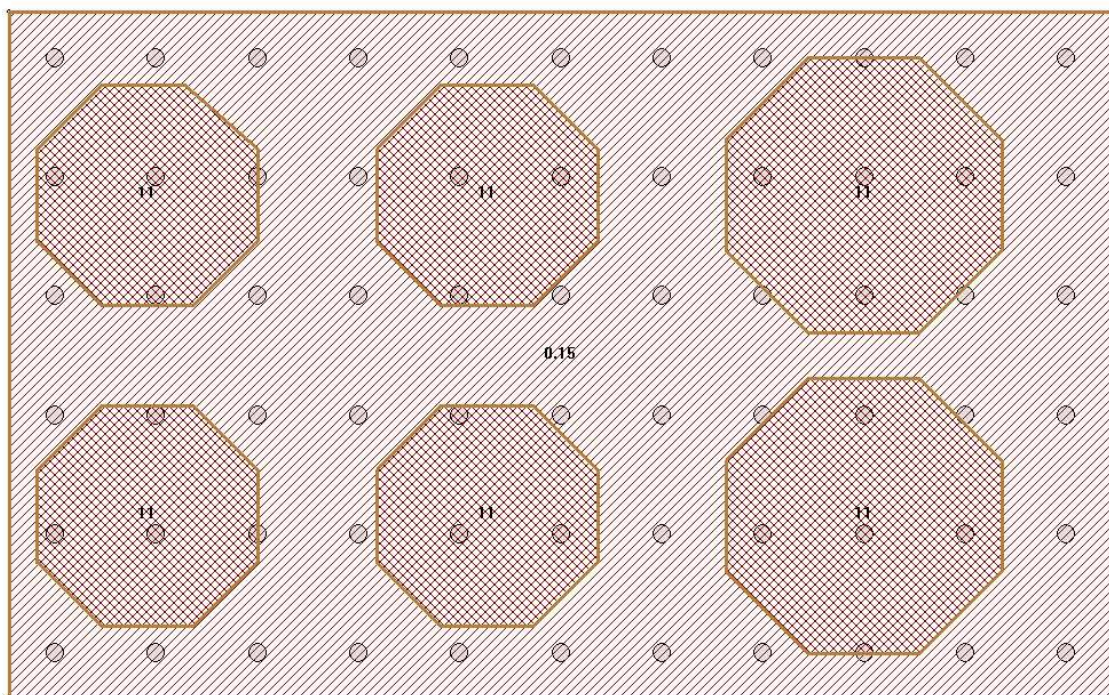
Фундаментна плита з рівномірно розподіленими навантаженнями
